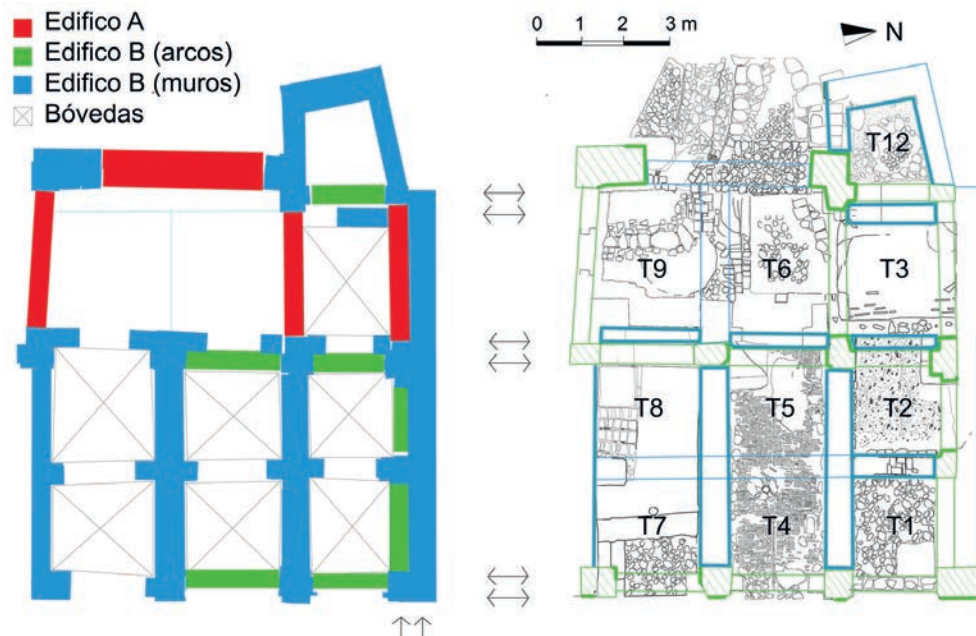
DISTRIBUCIÓN DE LOS MUROS Y DOBLES MUROS DE LA FASE B DE LA PLANTA BAJA DE TORNERÍAS
